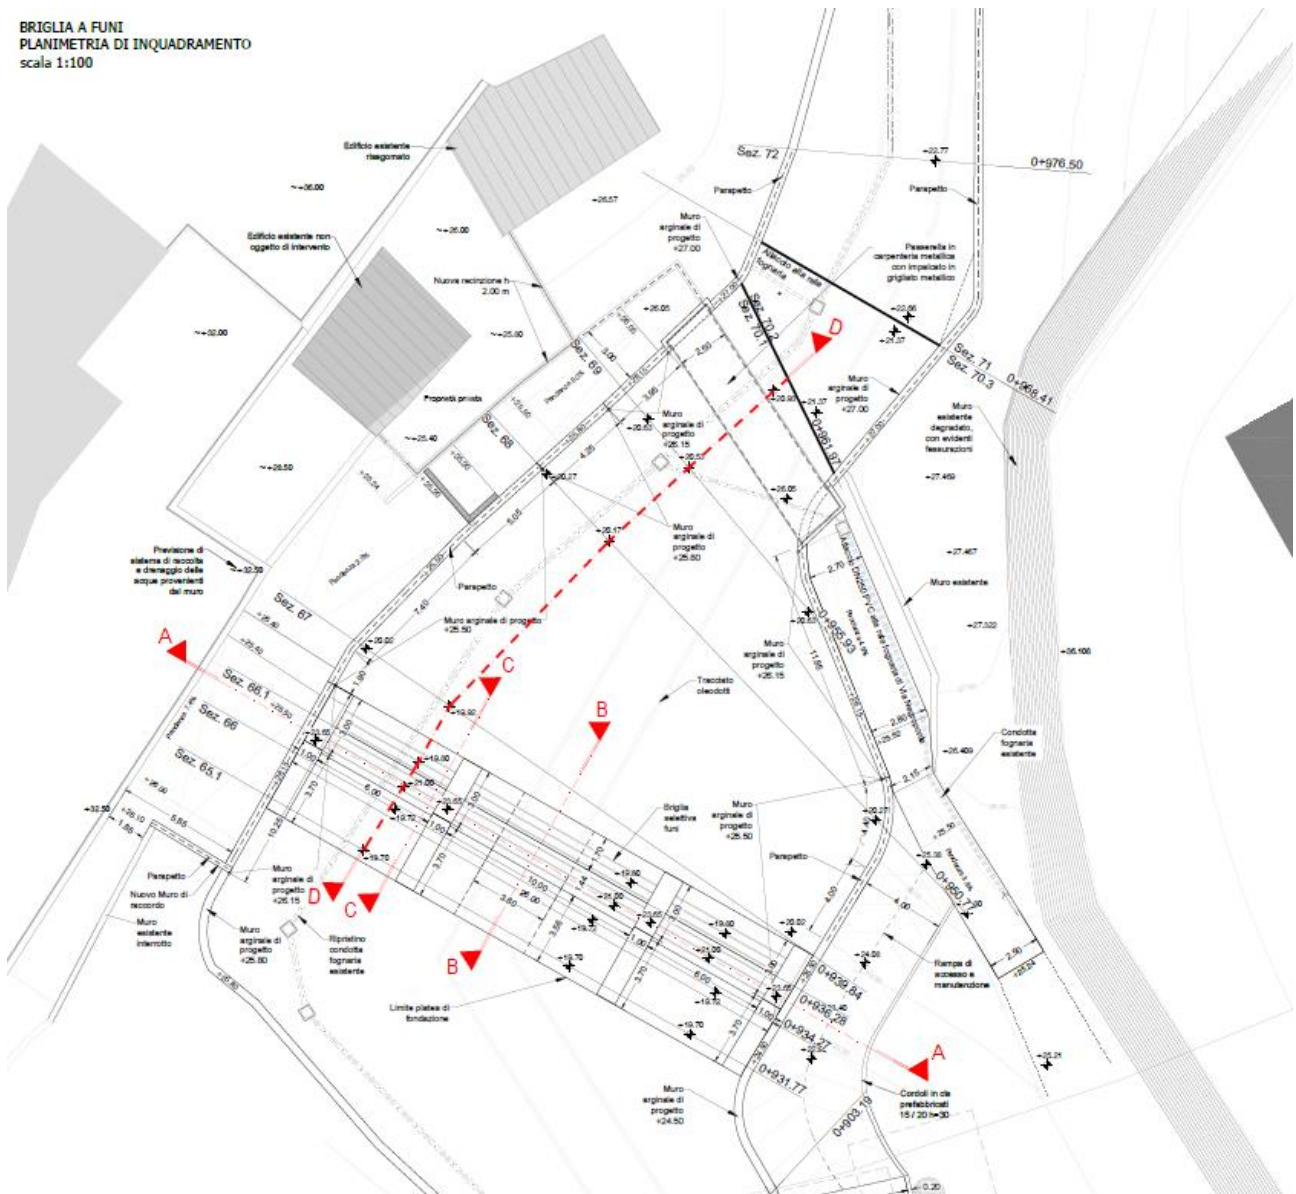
Rio Molinassi. Briglia di Monte e vasca di accumulo dei sedimenti. Planimetria generale
